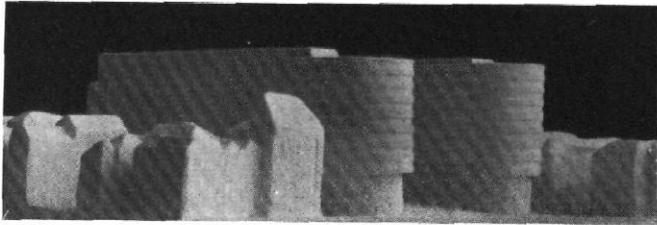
/ Aus dem Entwurf „Rampenbebauung“ / Architekt: A. G. Schneck, Stuttgart
